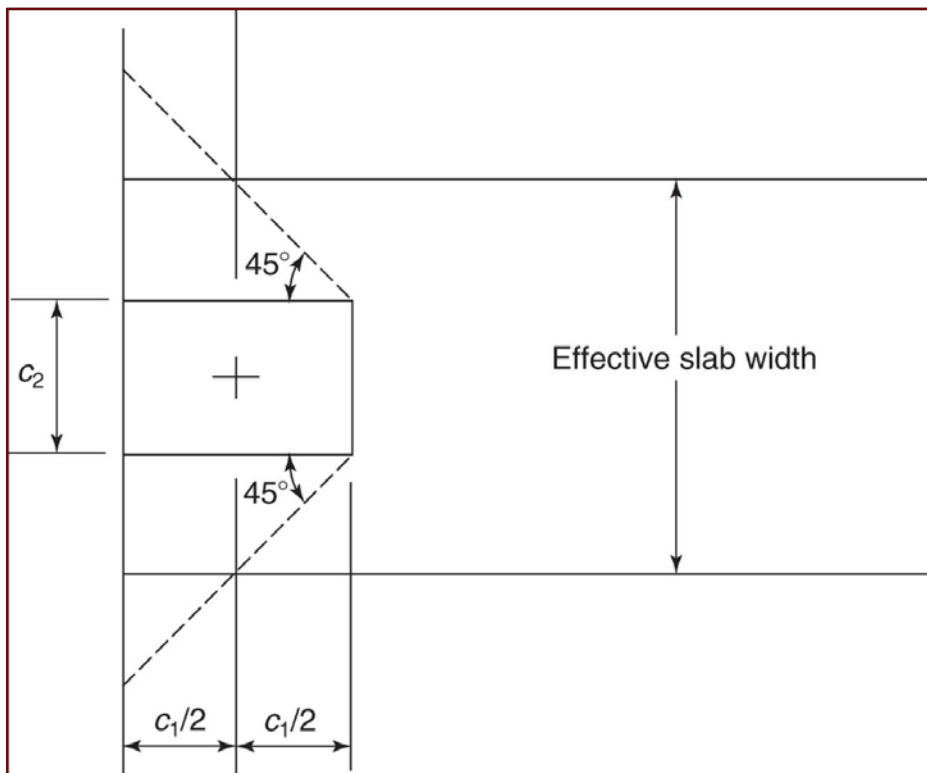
Valor mínimo para ancho efectivo de losa en conexiones losa columna exteriores.
